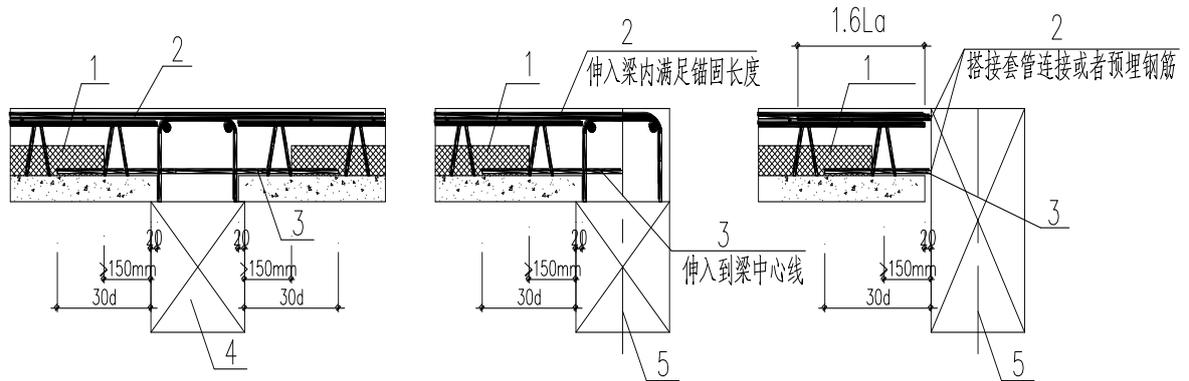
叠合板受力端与梁钢筋连接构造
